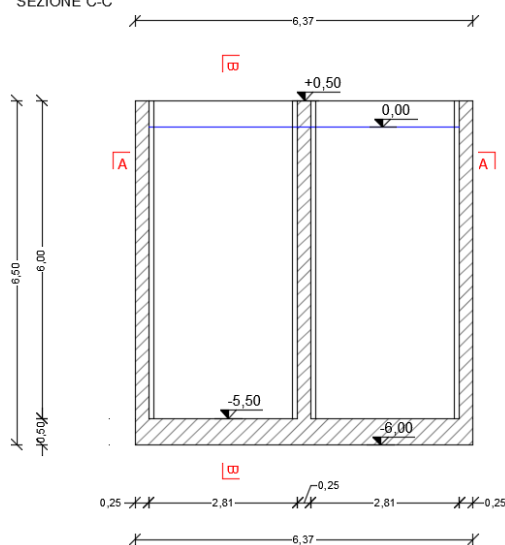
Cassone tipo G2: carpenteria – Sezione verticale C-C
